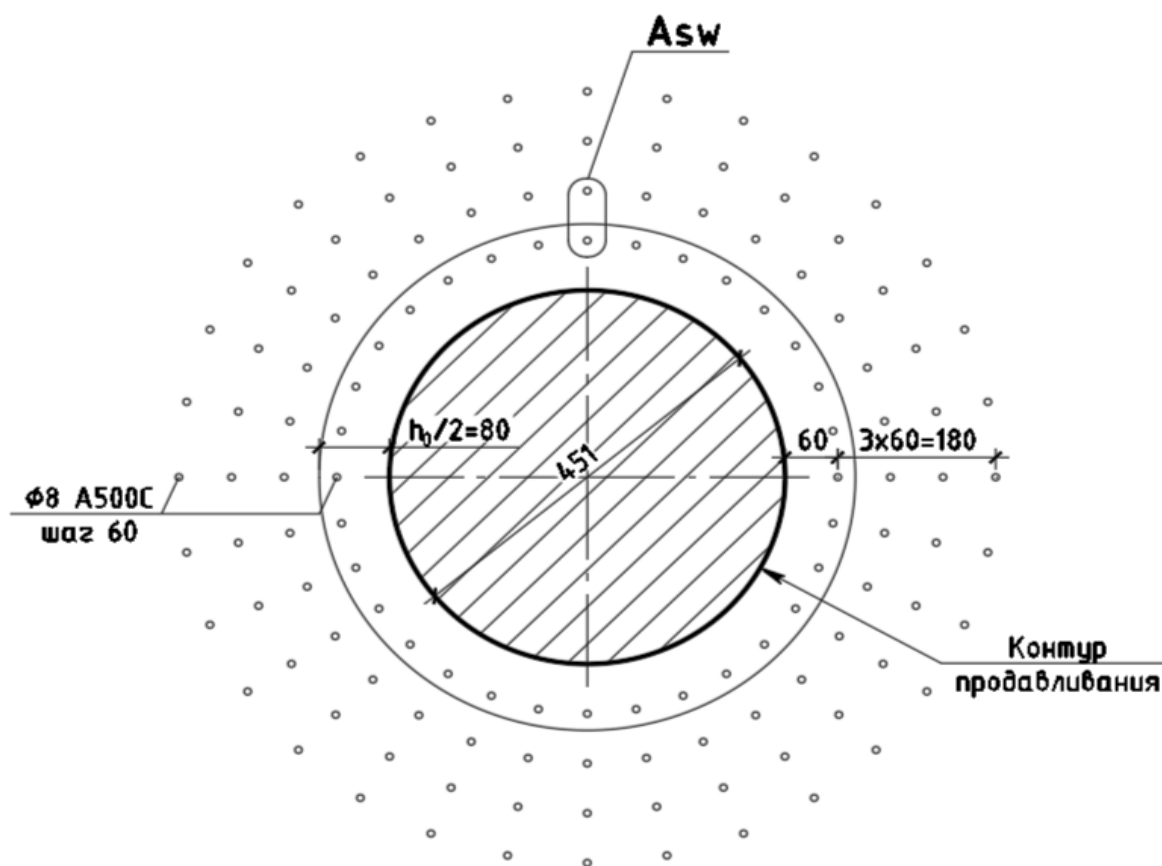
Схема для расчёта прочности плиты перекрытия на продавливание колонной круглого сечения диаметром 451 мм
